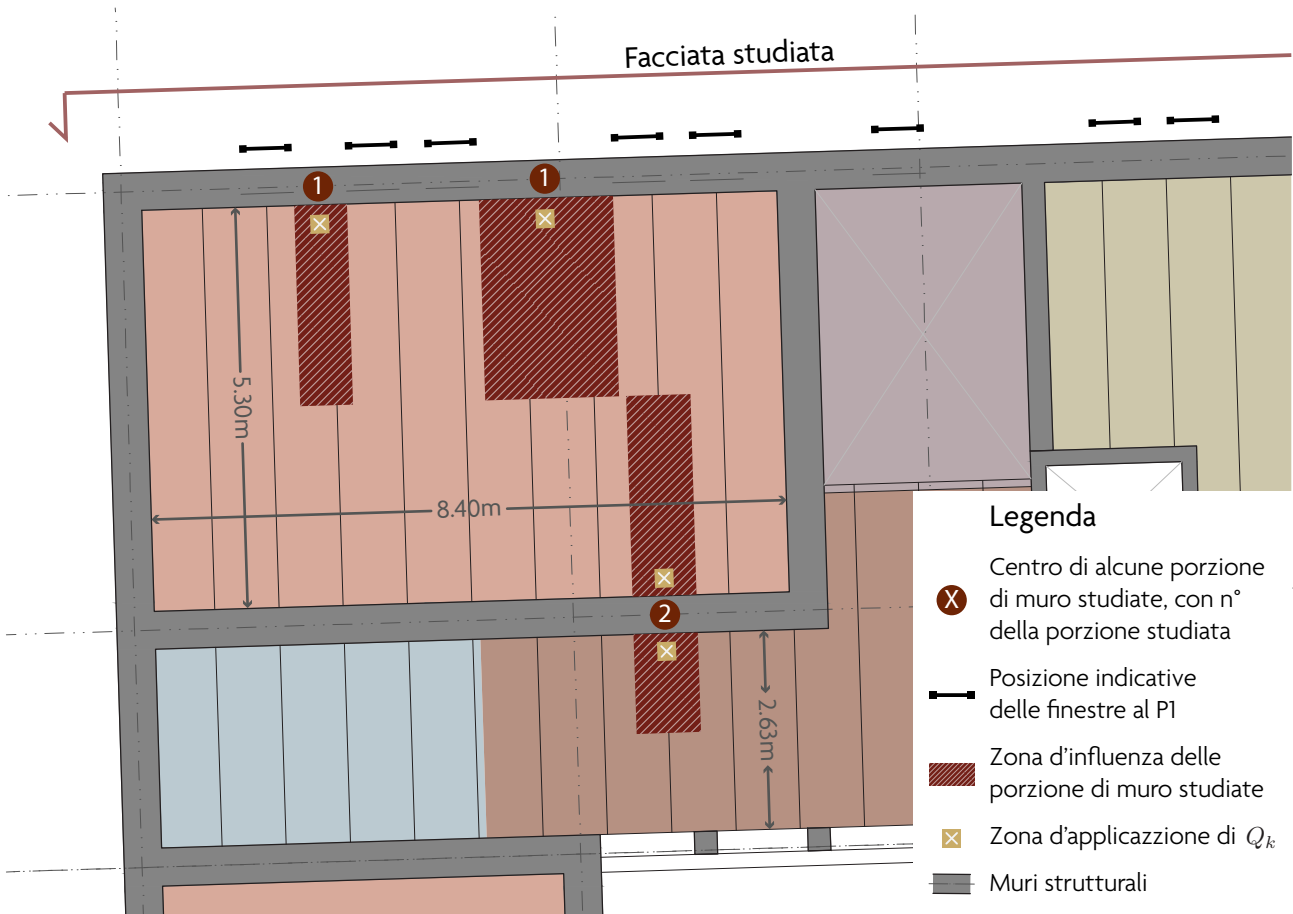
Impalco strutturale dello piano terra con le zone d'influenza di porzioni del muro da analizzare (per la soluzione strutturale n°1 nel caso della prima zona - in facciata).
